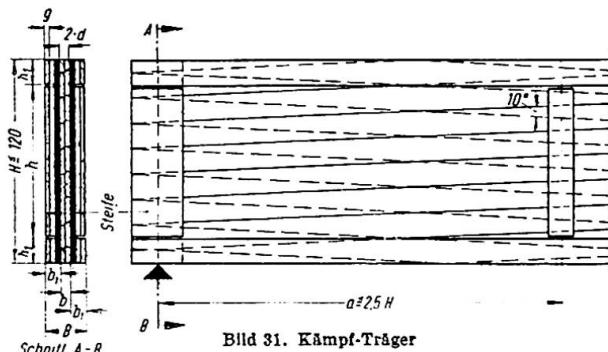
Kämpf-Träger (I-Träger) mit Brettersteg
